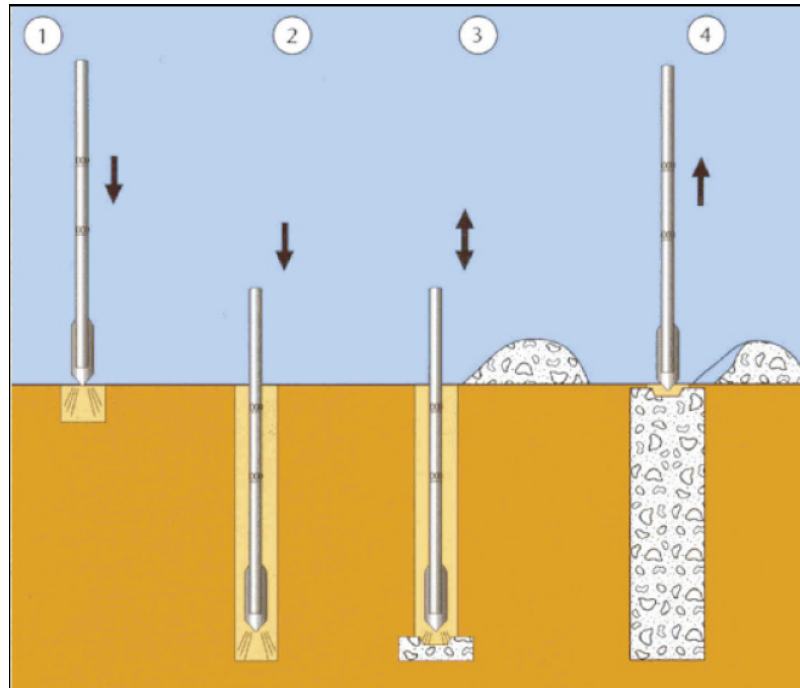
Secuencia constructiva de columnas de grava: (1) Inyección de vibrador (2) Alcance profundidad requerida (3) Aporte de grava, movimiento escalonado (4) Extracción del vibrador, fin faena.
